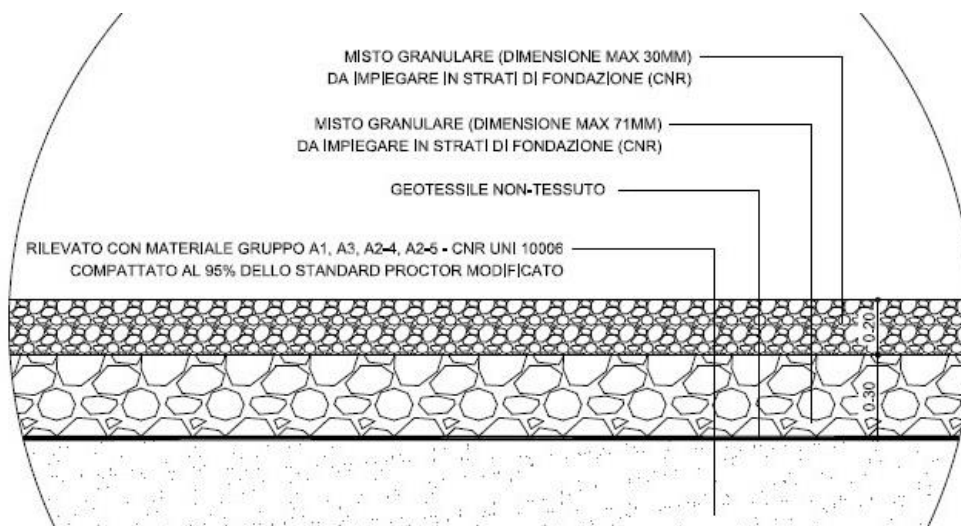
Pacchetto pavimentazione in misto granulare
